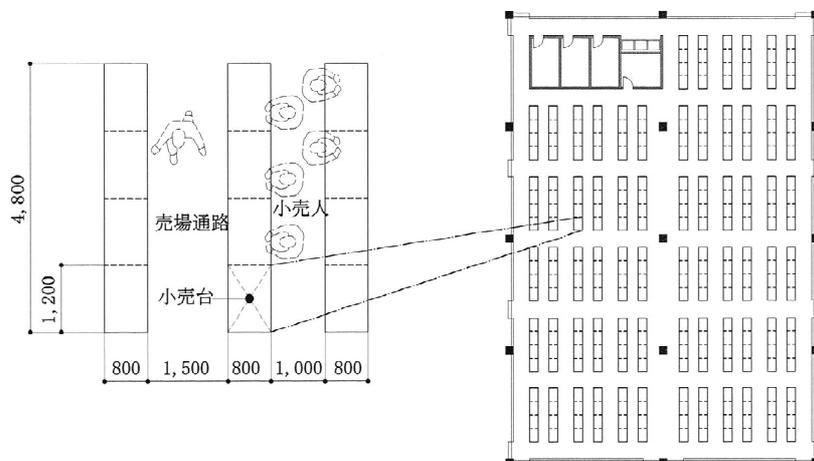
5 小売場の仕様と全体配置図 (単位：mm)
